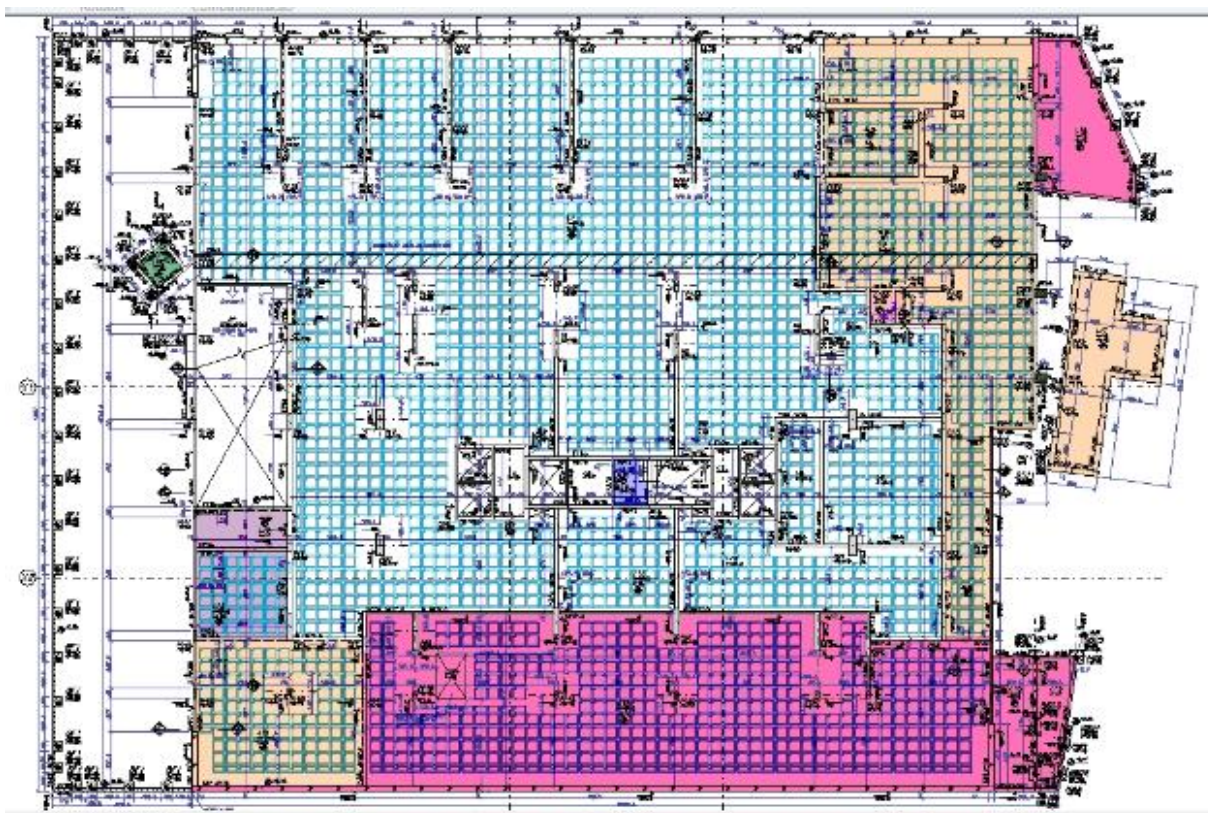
Fôrma do pavimento térreo - opção com laje nervurada.
